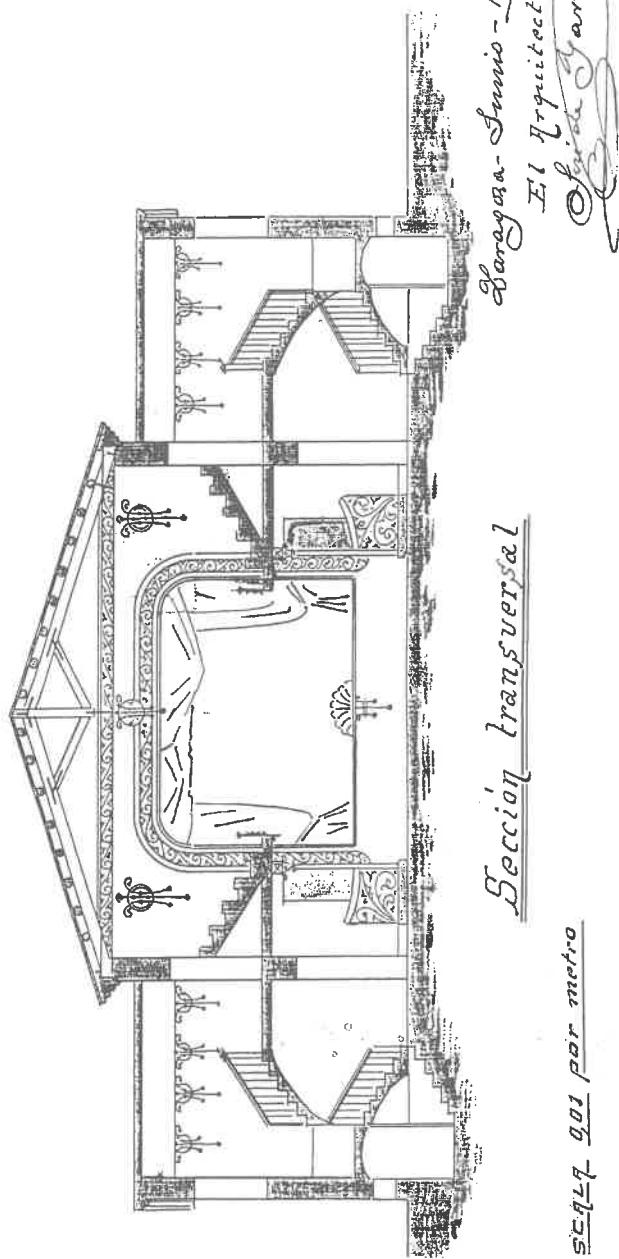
Plano con la sección transversal del teatro de Aleca proyectado por José de Yarza (1906), conservado en el archivo privado de su familia.
